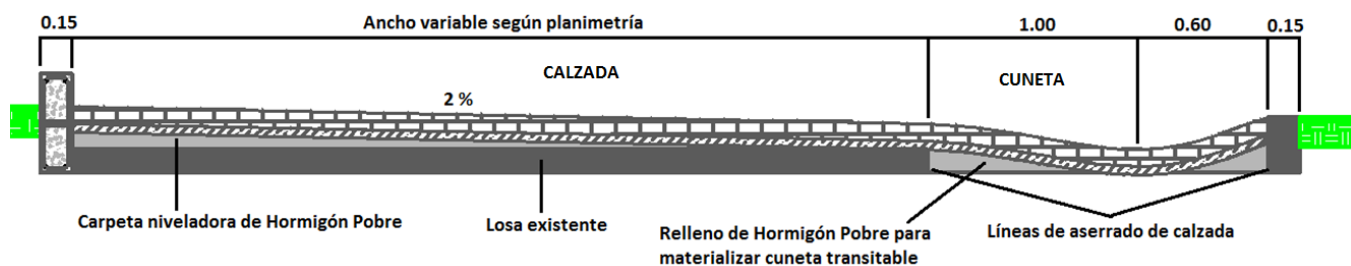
Perfil Tipo T 1 utilizado para el cómputo de Hormigón Pobre
